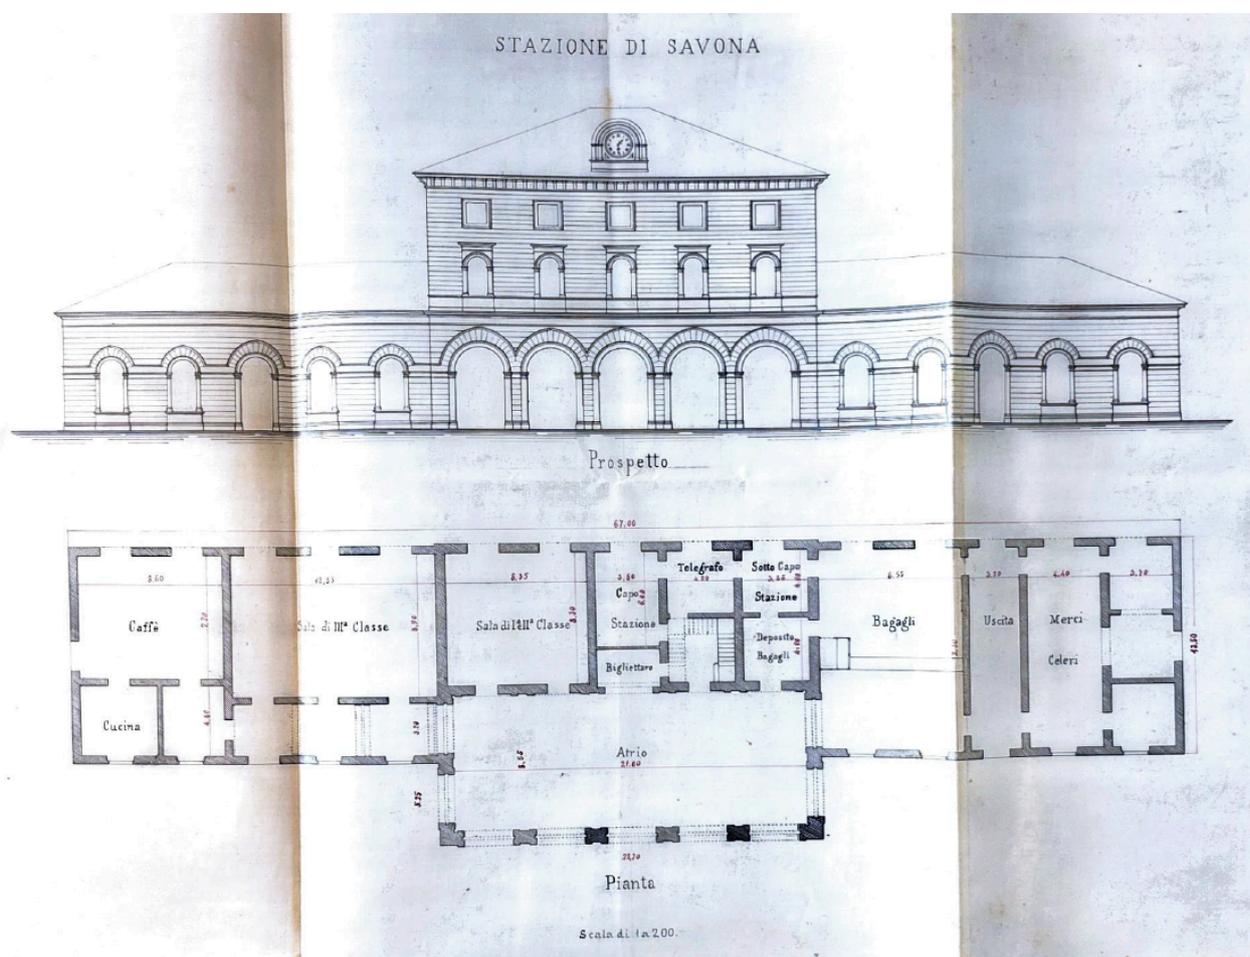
Prospetto principale e pianta della Stazione di Savona (Archivio di Stato di Savona, Lavori Pubblici, Serie III, Cartella 430, Classe 3, Fascicolo 6).
